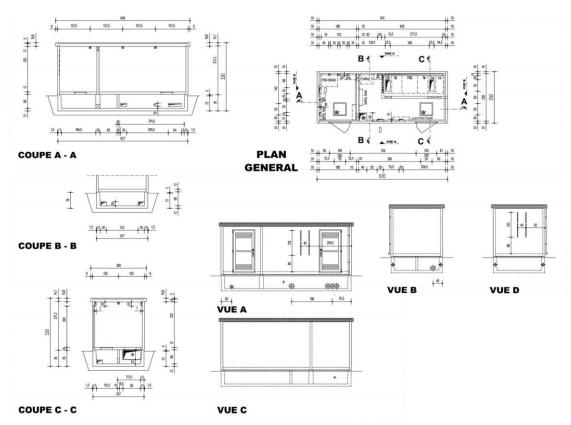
Plan de facade et de toiture du poste de livraison (source: ENERCON, 2016)
